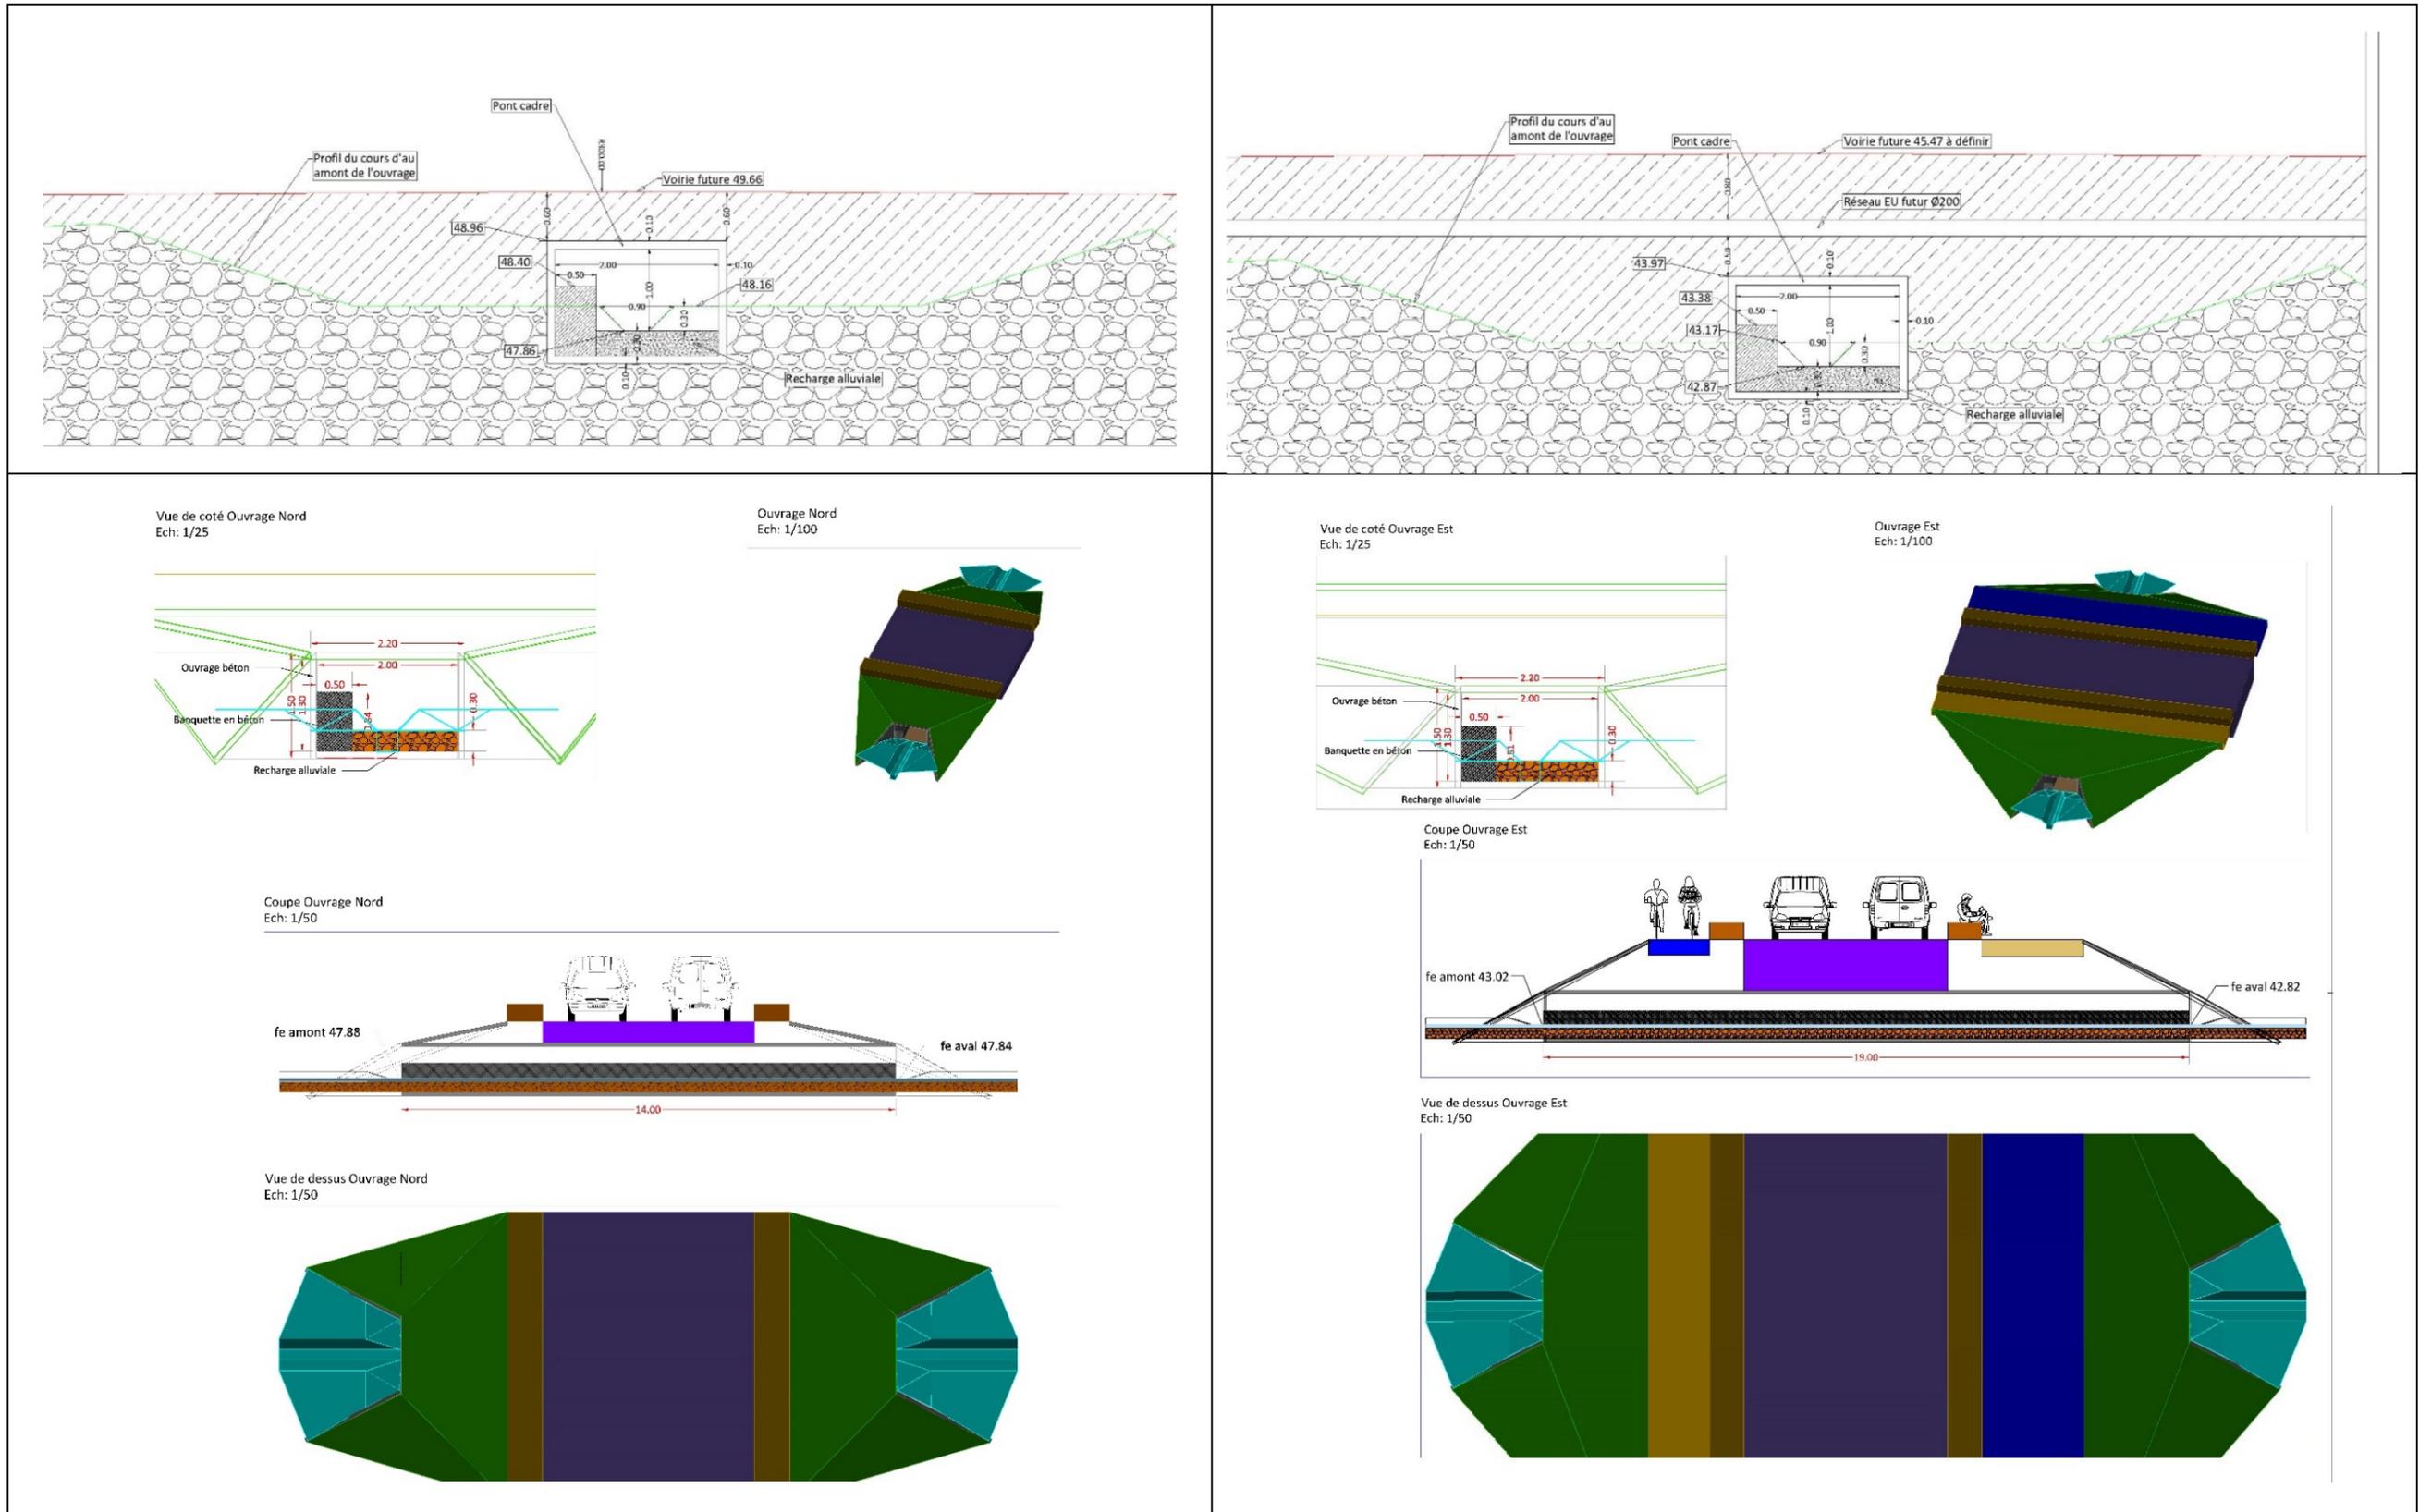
Plans de détail des franchissements de cours d'eau par pont-cadre (voir également annexe)
